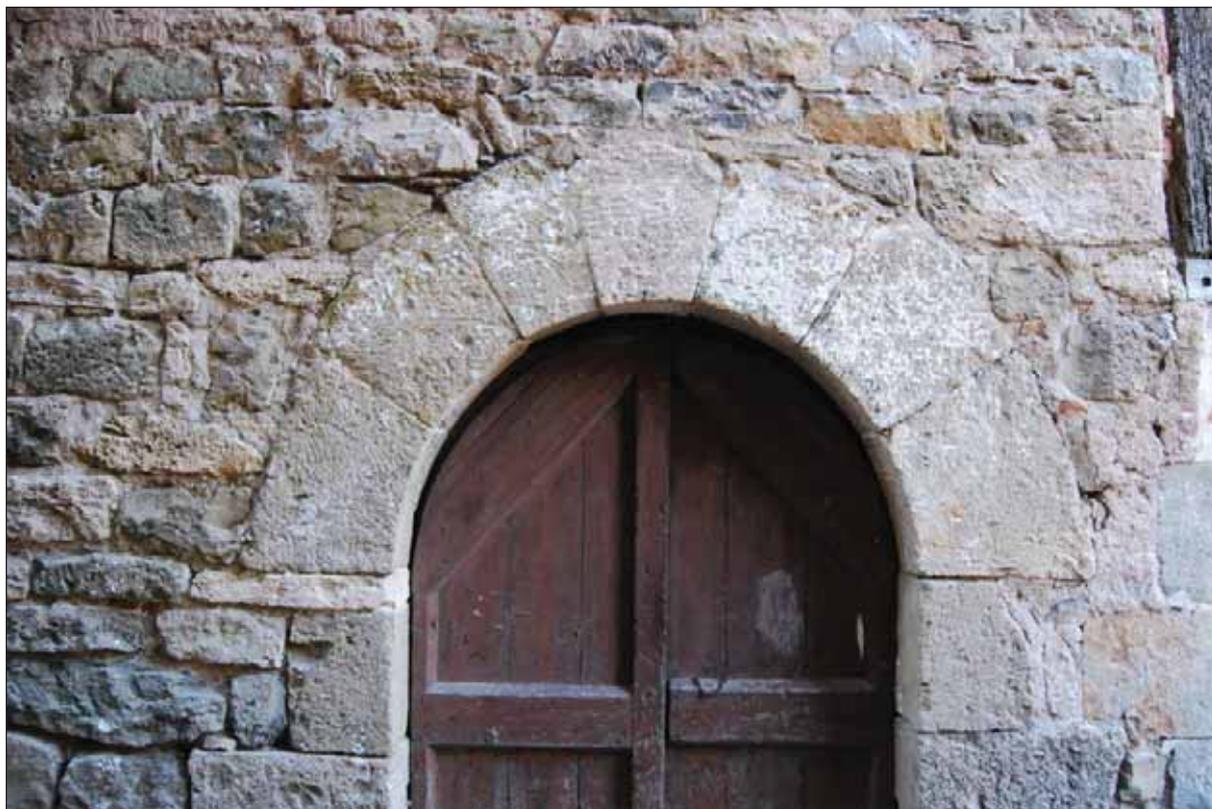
partie centrale de la parcelle, façade sur la rue du Bessarel
